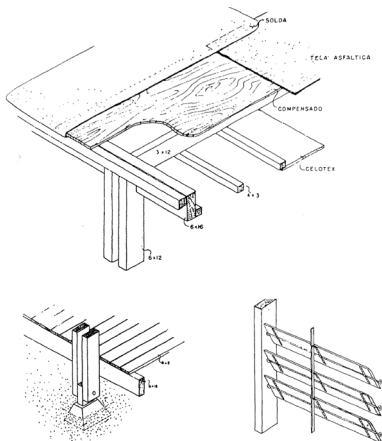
Detalhes construtivos da cobertura, sistema estrutural e lâminas do quebra-sol.
